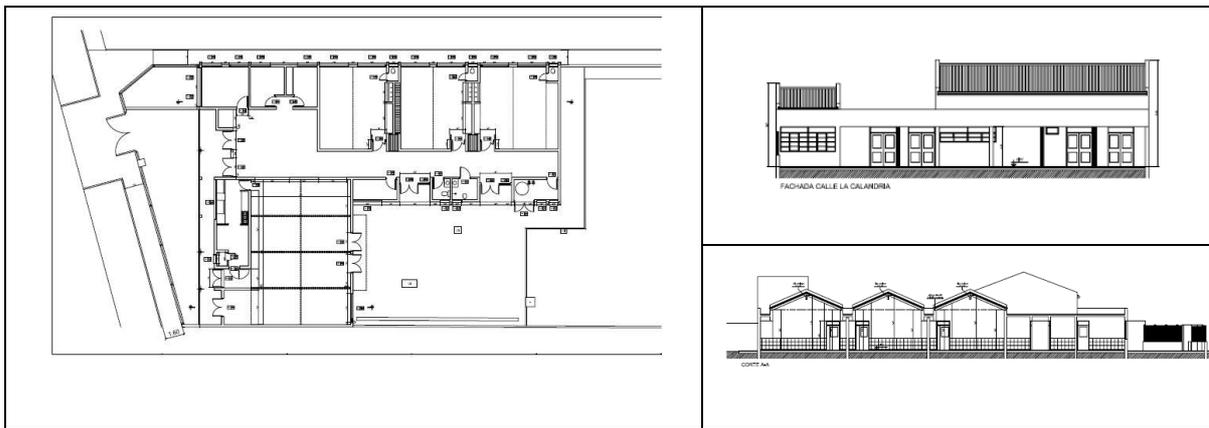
Planta, corte y vistas Escuela de Educación Inicial Barrio San José.
